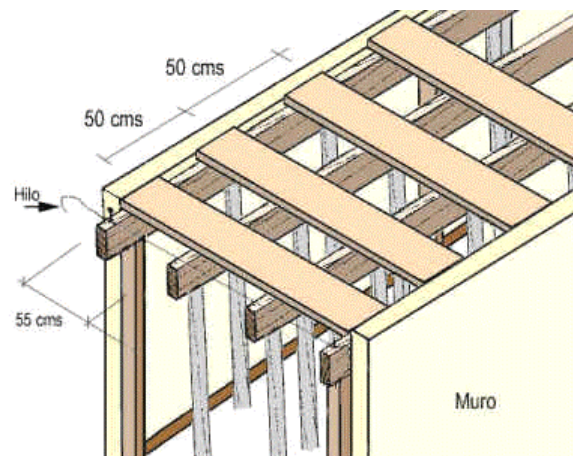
ENCOFRADO TRADICIONAL DE MADERA
